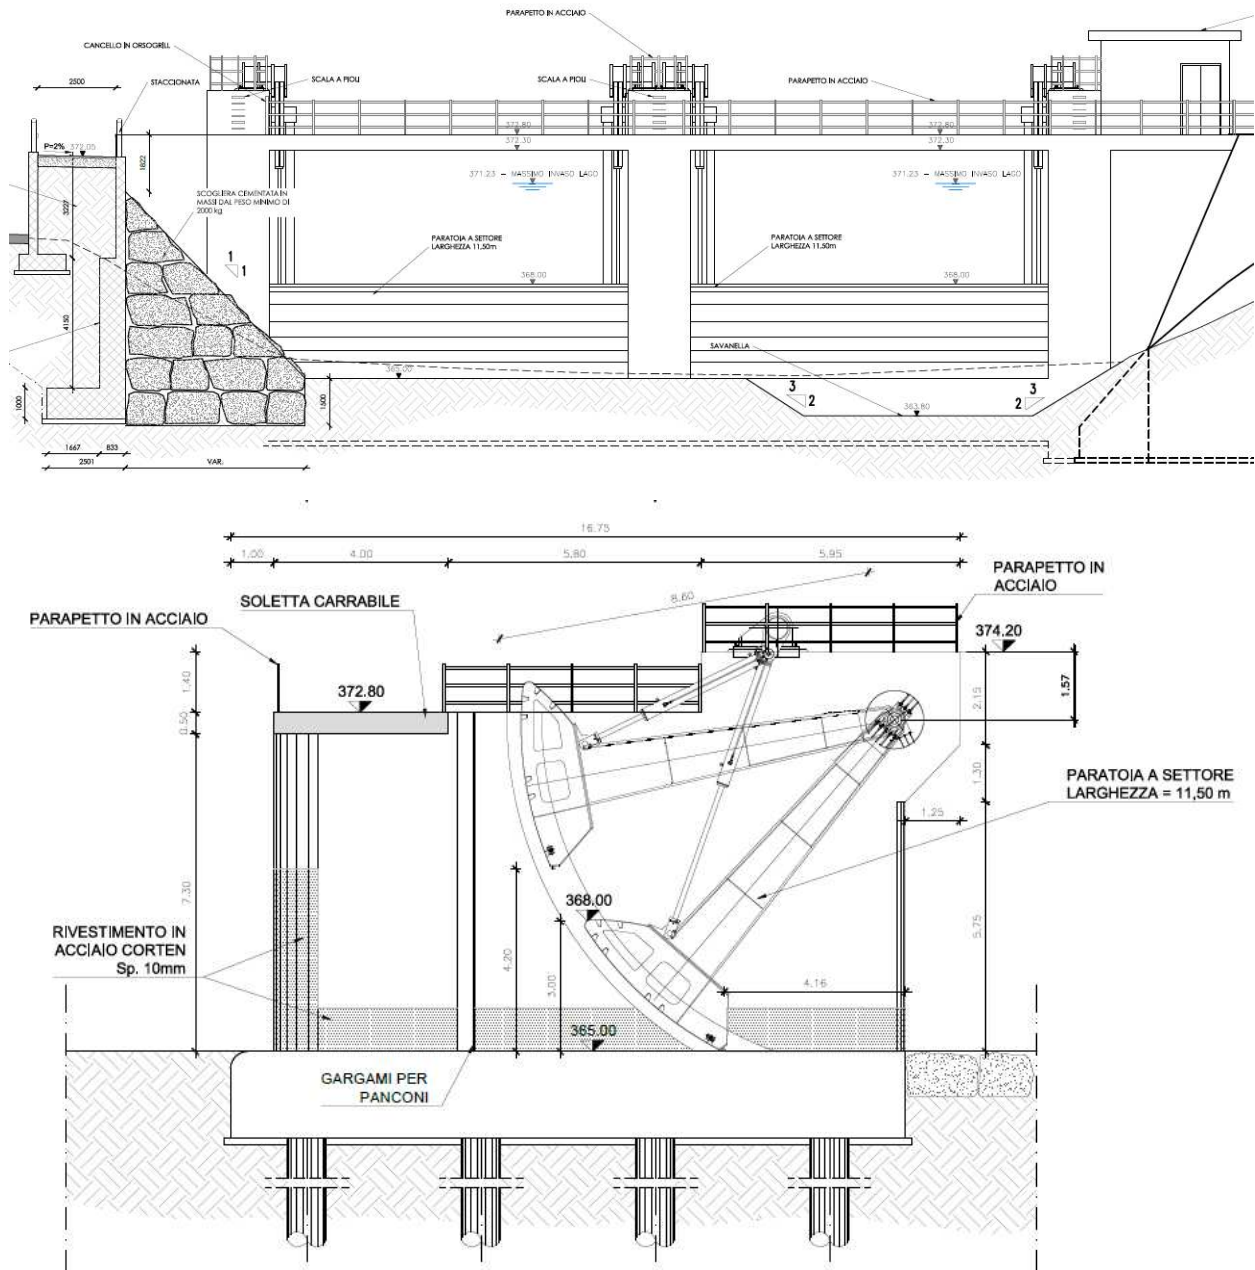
Vista prospettica da monte e sezione longitudinale della nuova traversa
